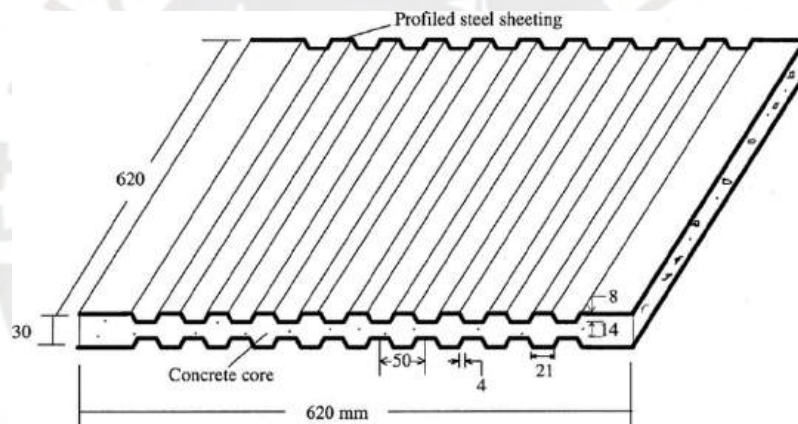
Vista de elemento mixto – perfil de acero y concreto
